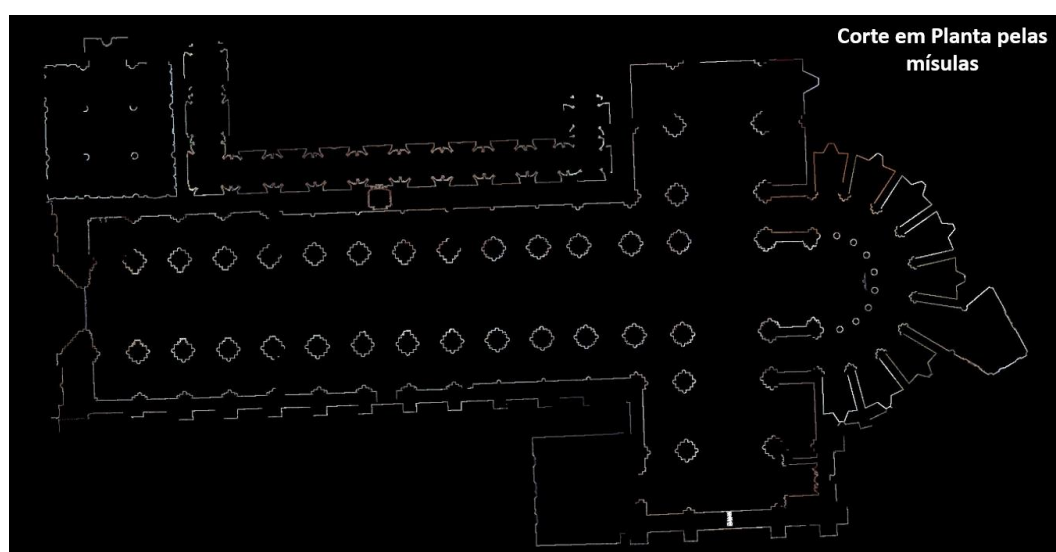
Corte em planta pela altura das mísulas piramidais dos pilares da Igreja do Mosteiro de Alcobaça.
